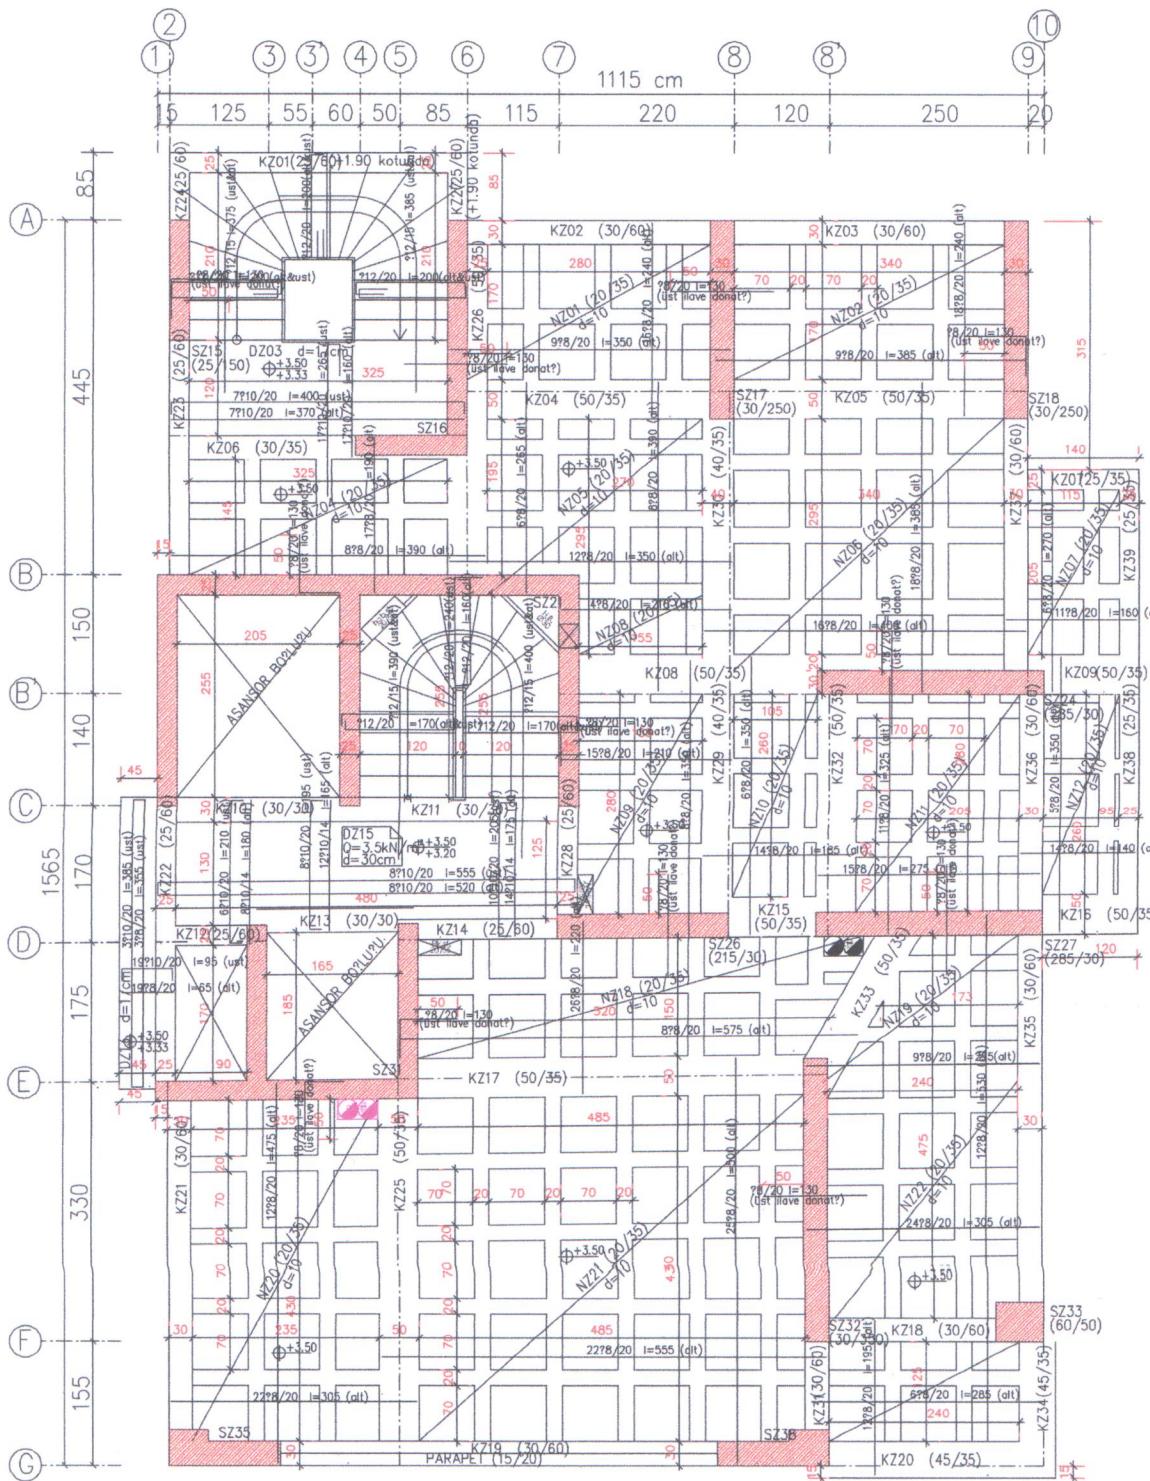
Fenerbahçe Konut Binası Temel Kalıp Planı
